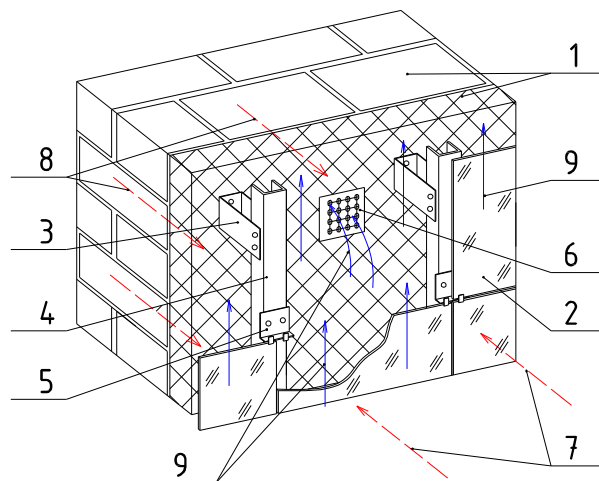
Схема конструкции фасада здания с рекуперативными приточными вентиляционными блоками, тепловых и воздушных потоков в конструкции:
